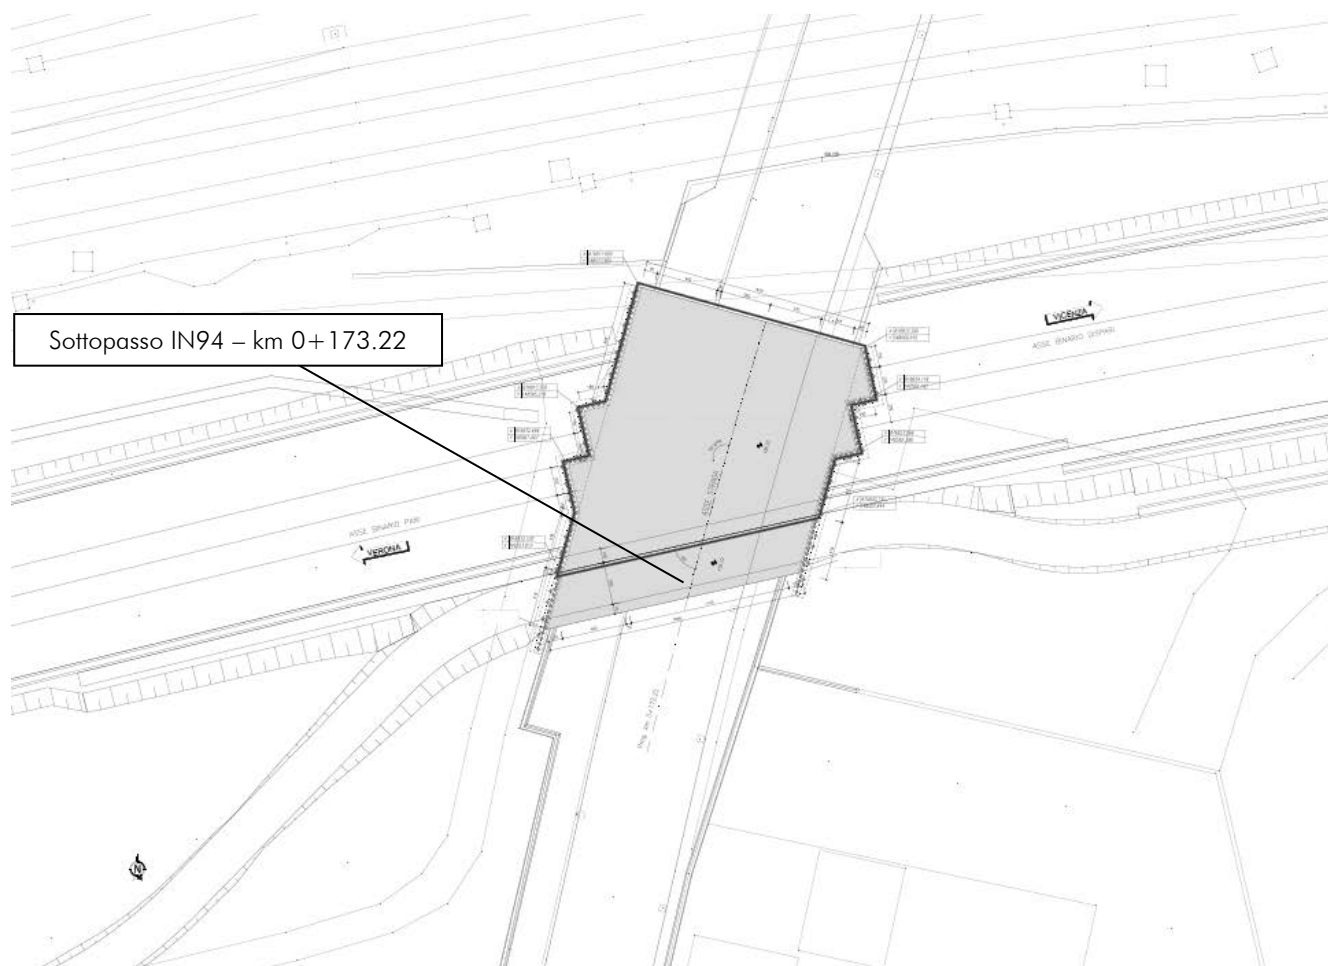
Stralcio planimetrico – Ubicazione Sottopasso IN94
